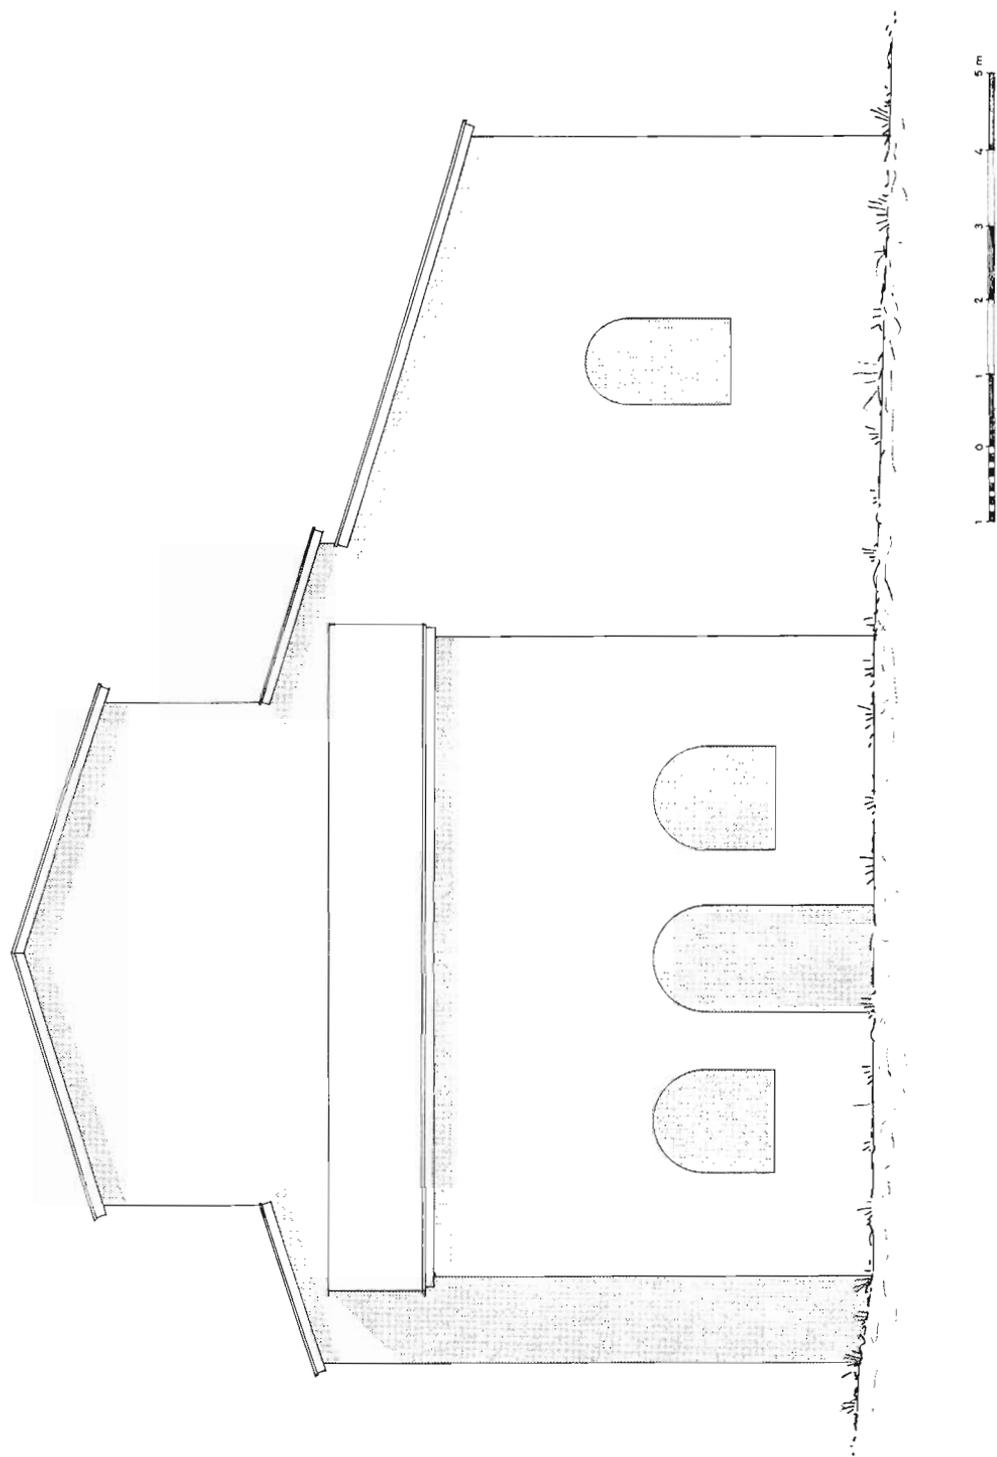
San Pedro en Veranes: alzado fachada Oeste, con pórtico y baptisterio (reconstrucción, según Manzanares)
